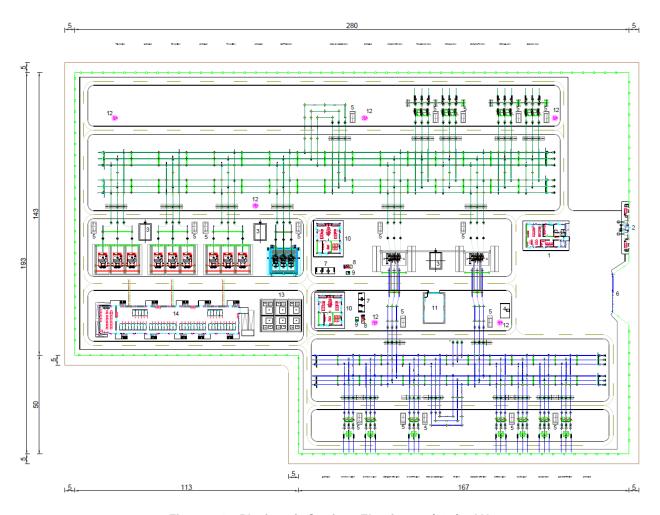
Planimetria Stazione Elettrica 220/132/36 kV
